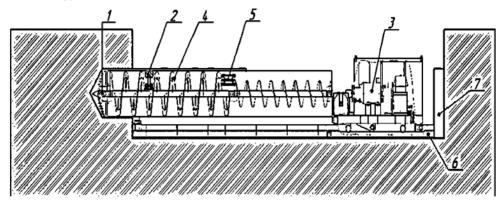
Установка для шнекового бурения скважин в грунте 1 — рабочий орган; 2 — передняя подвеска; 3 — установка для бурения скважины; 4 — шнековый транспортер; 5 — задняя подвеска; 6 — упорная рама; 7 — упорная стенка
